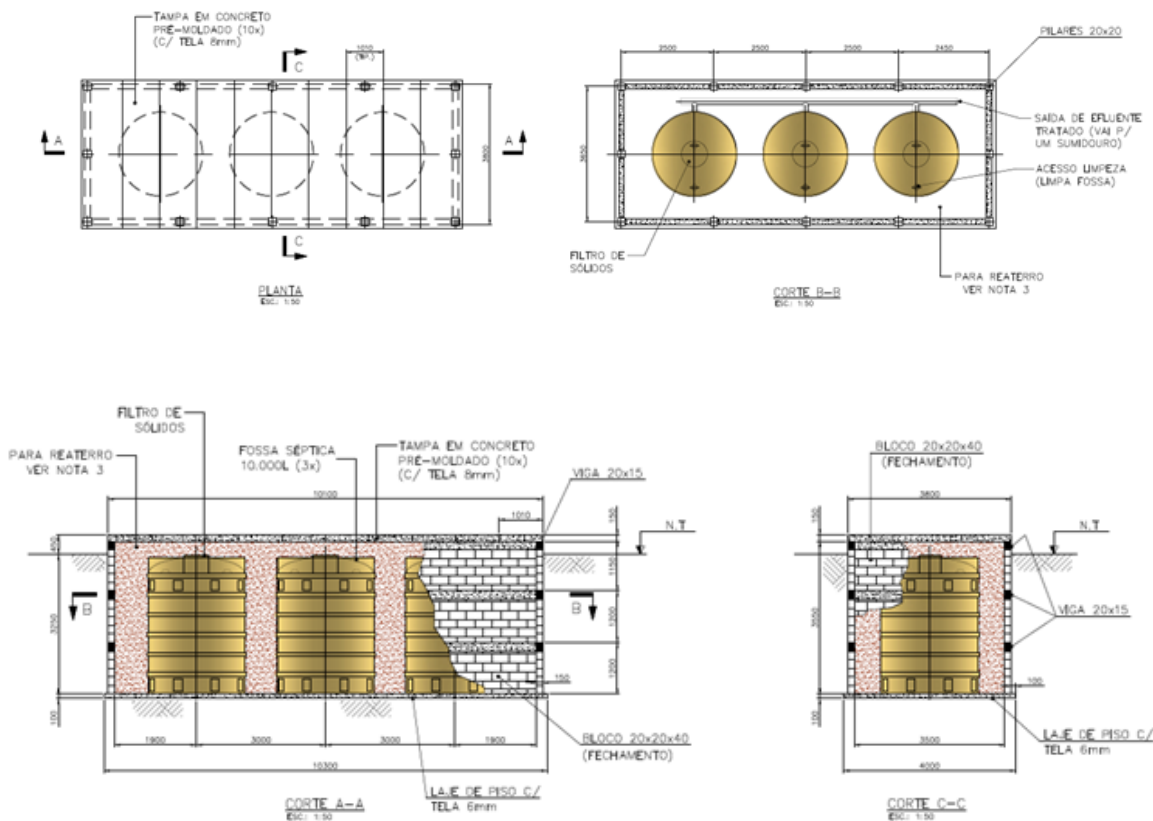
Detalhes em planta e cortes – Fossa Filtro.
